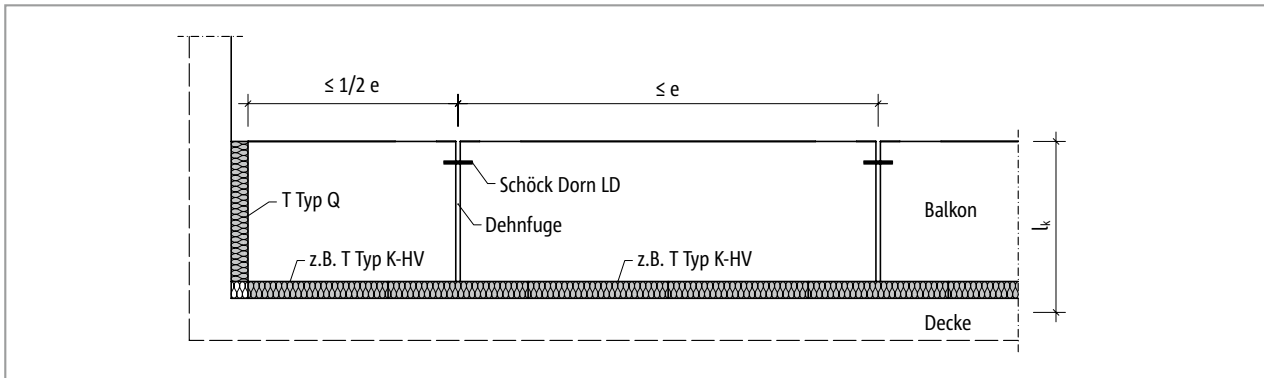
Schöck Isokorb® T Typ K-HV: Dehnfugenausbildung mit längsverschieblichem Querkraftdorn, z. B. Schöck Dorn
